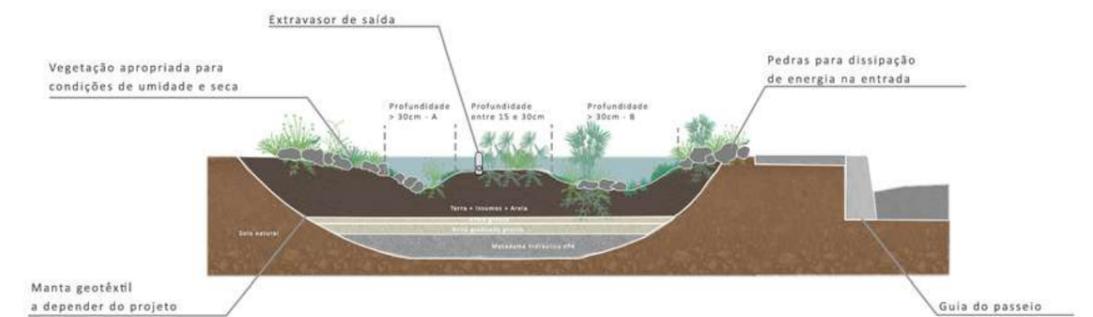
Canteiro pluvial sem paredes laterais e laje de fundo, sem tubulação/duto de conexão sem drenagem convencional existente (Fonte: Guajava, 2023)
